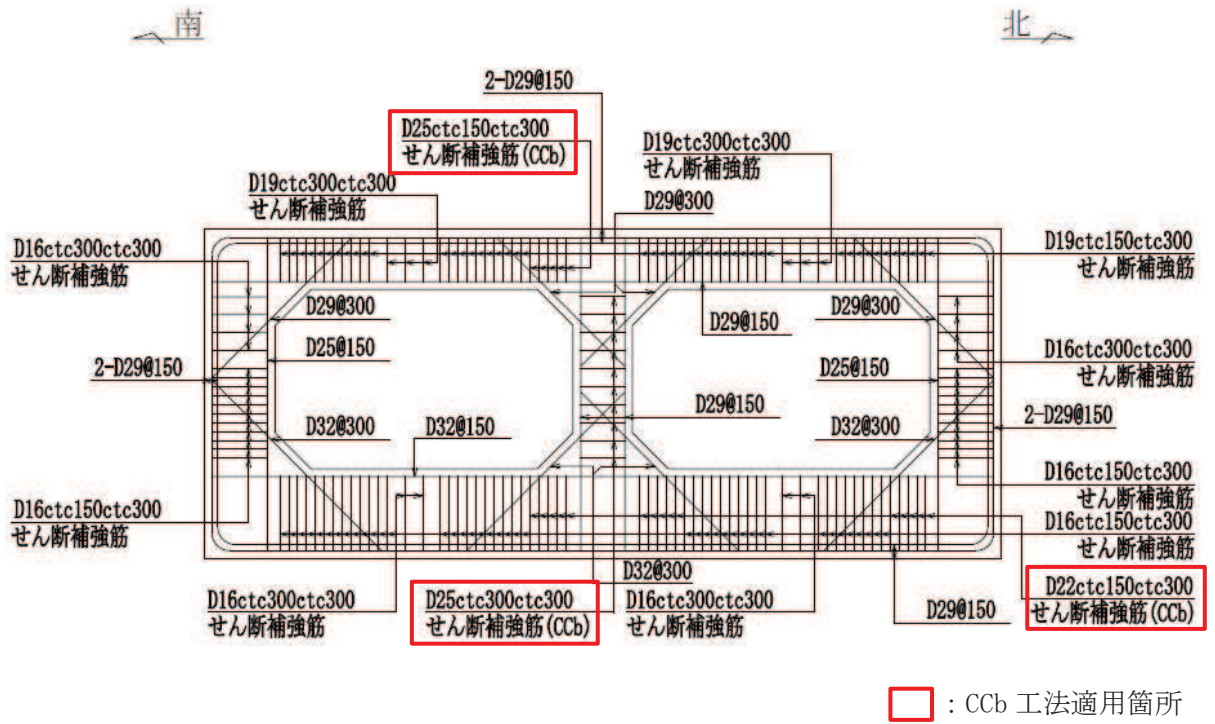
取水路 (標準部) 概略配筋図 (A-A 断面)
